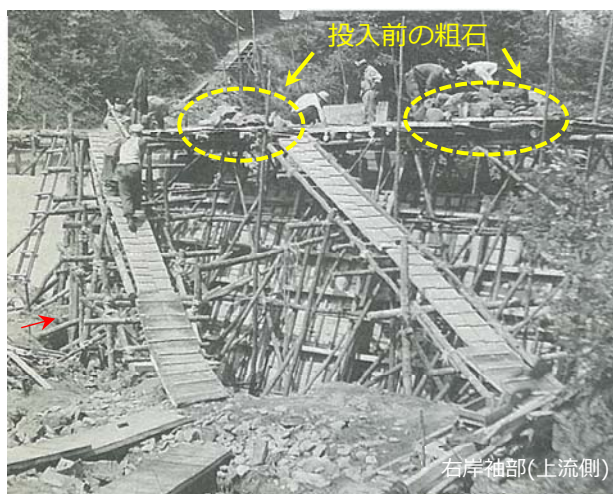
新川水系琴似発寒川平和堰堤 粗石コンクリート施工中の例 (S30)
